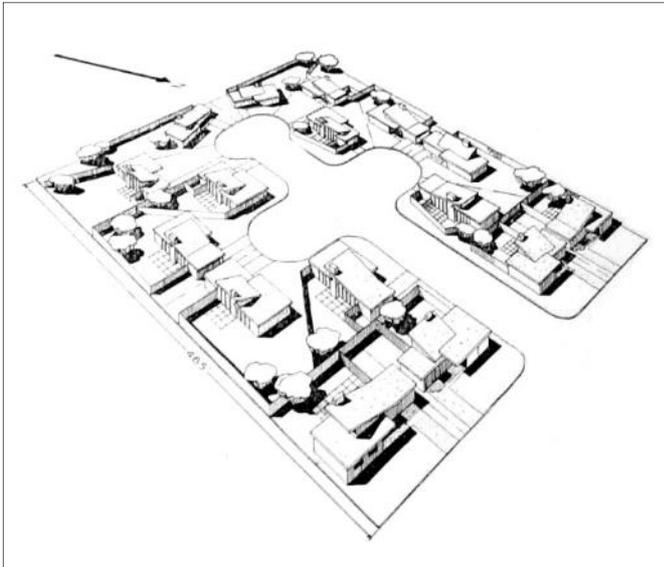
La planta muestra la variedad de modelos y las calles en fondo de saco. *Architectural Forum*. 1950.
